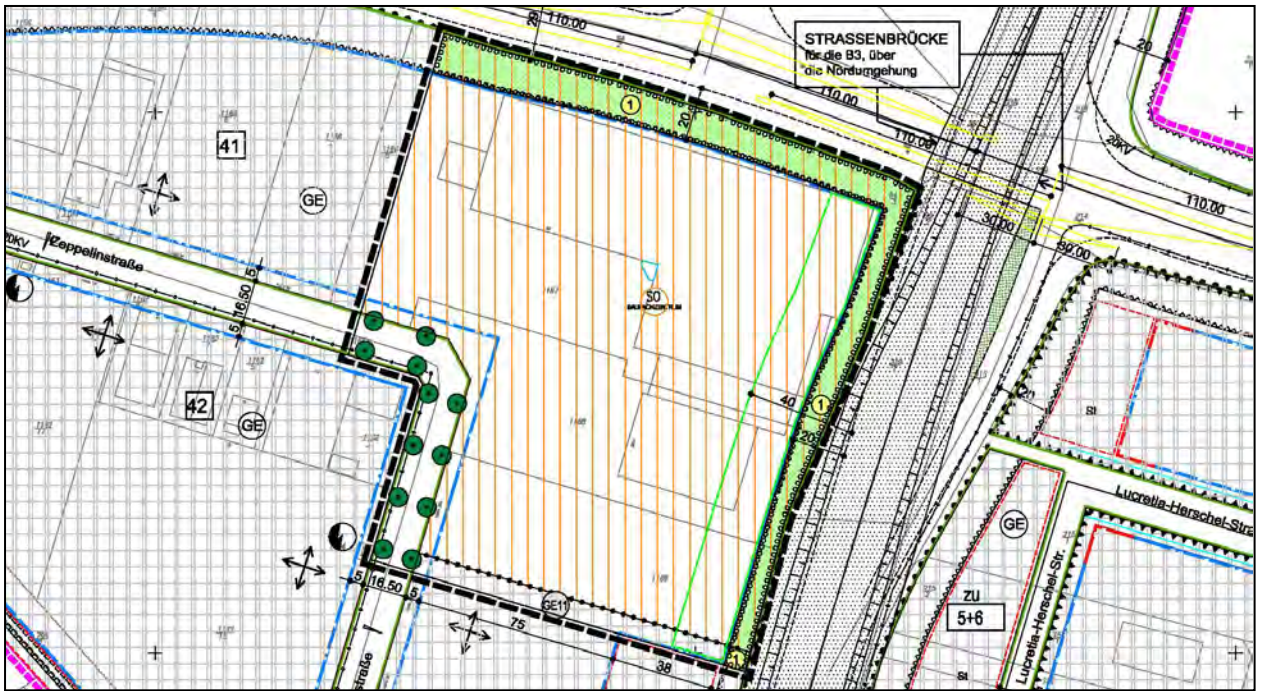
5. Änderung des Bebauungsplans „Krebschere“
